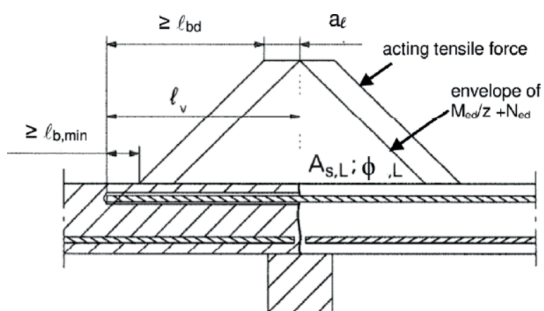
Anclaje final de losas o vigas (por ejemplo, diseñadas como simplemente apoyadas).
